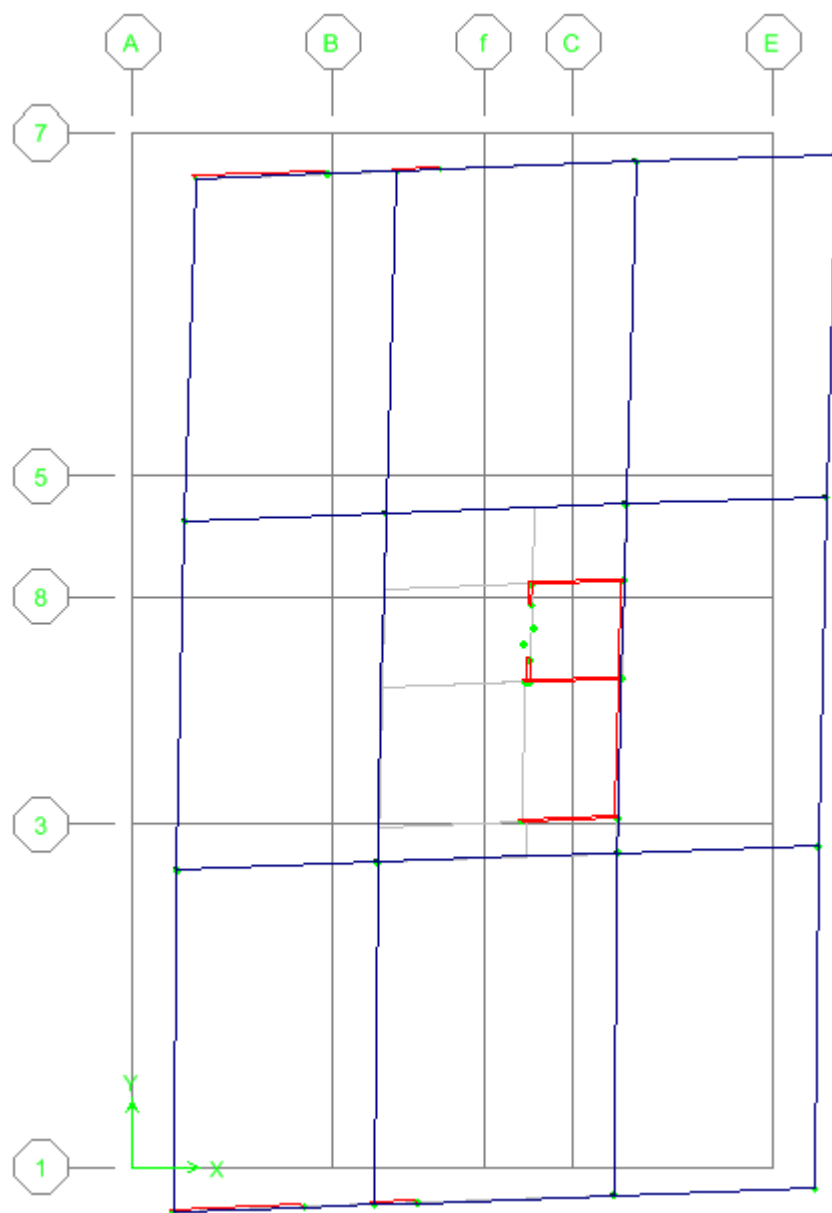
Figura VI. Deformada en edificación de área 360 m<sup>2</sup> con muros en planta.
